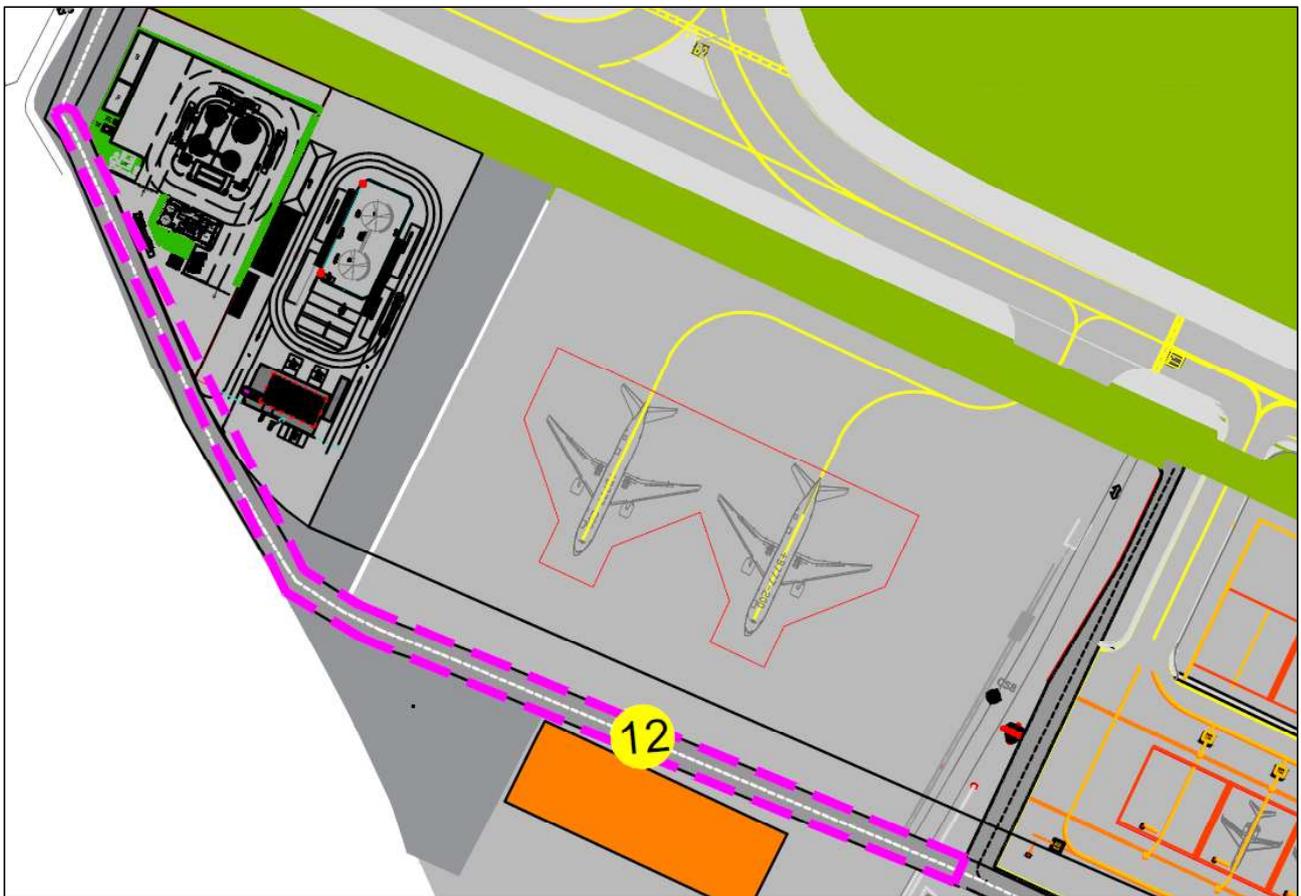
Estratto Master Plan – Nuova Viabilità Perimetrale
